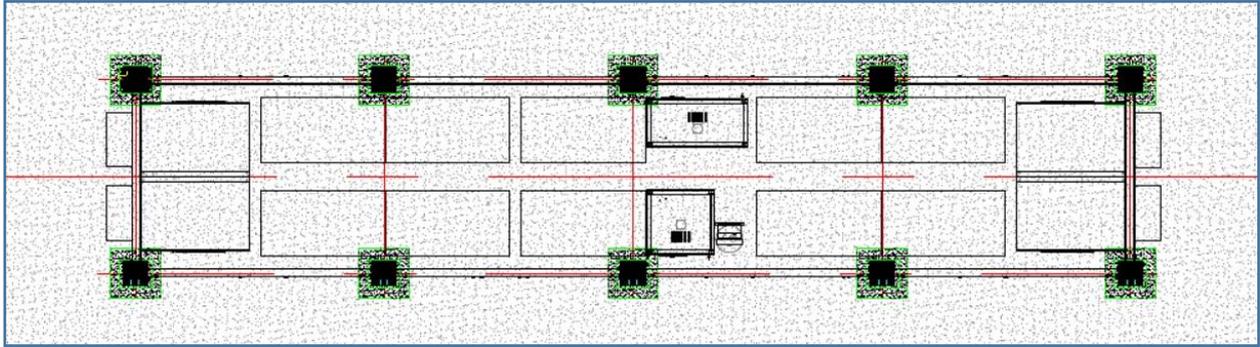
CABINATO PER BATTERIE (BESS) PROSPETTO PIANTA FONDAZIONI
